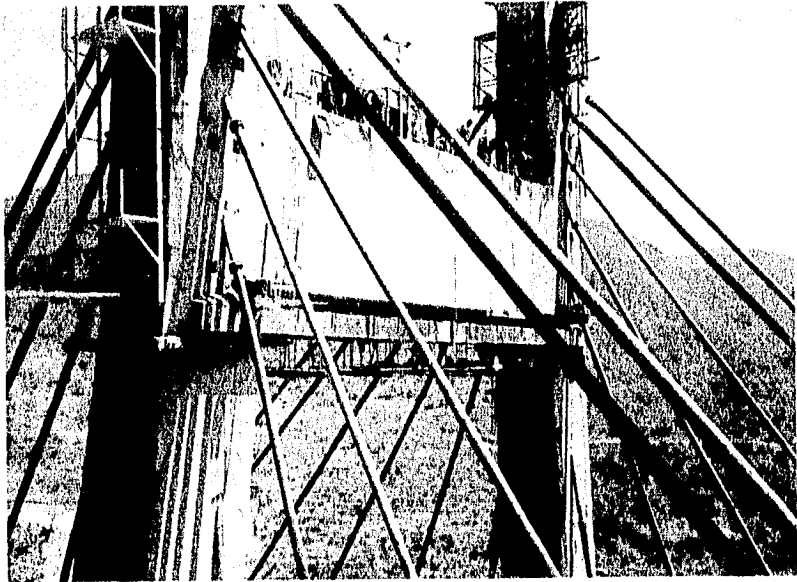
Vista general de Riostra en pila No. 2.
